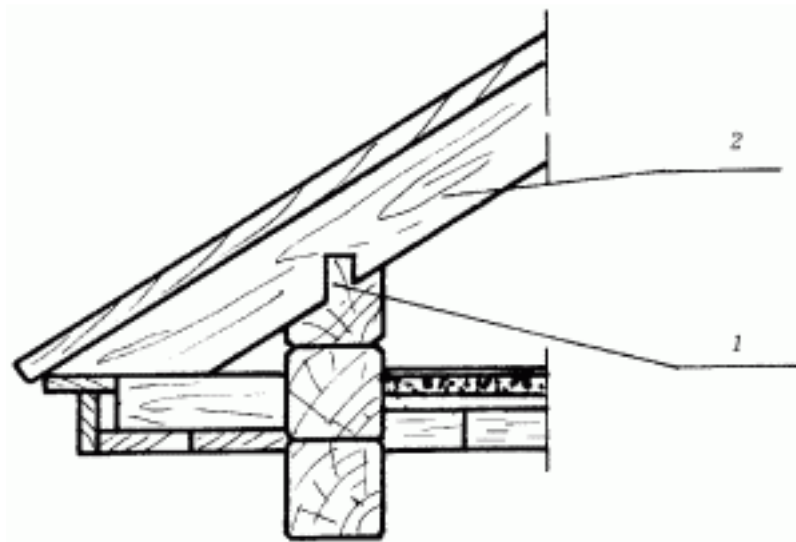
Опора наслонных стропил в деревянных брусчатых или рубленых домах: 1 – шип; 2 – стропильная нога.
